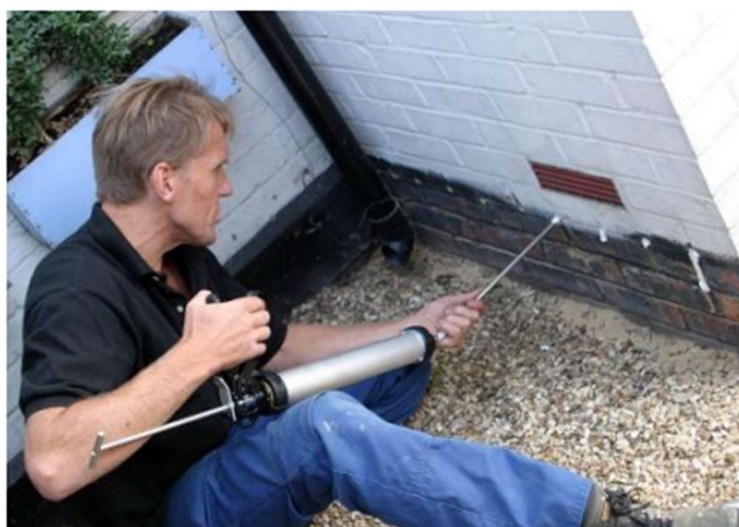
Processo de introdução em obra do impermeabilizante sob pressão
